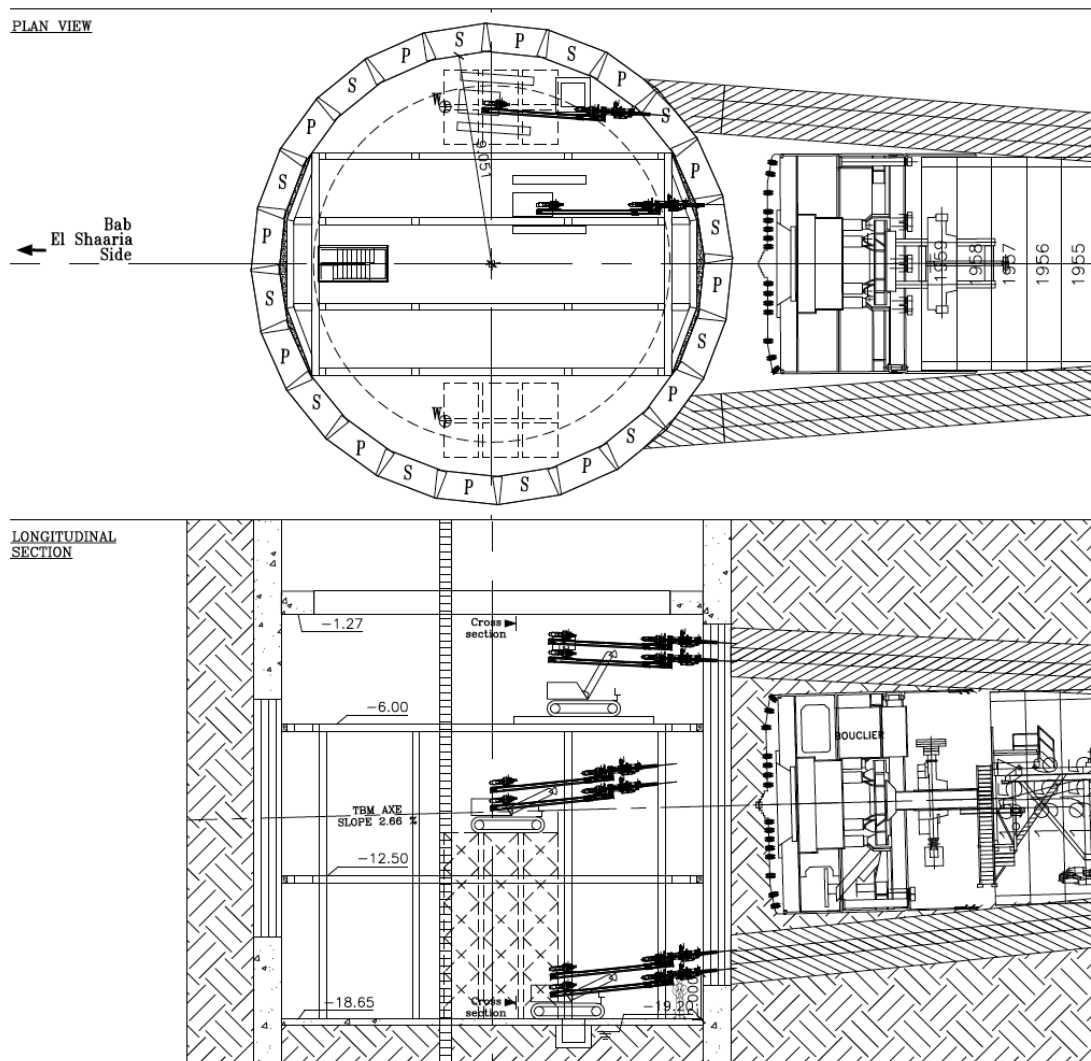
Grundriss und Schnitt des Schachtes und der TBM
